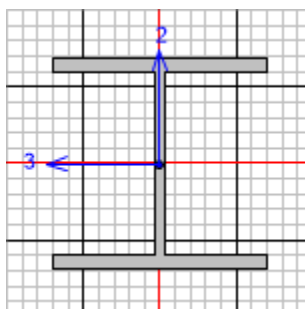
Origen del perfil de la columna. Fuente: SAP2000
